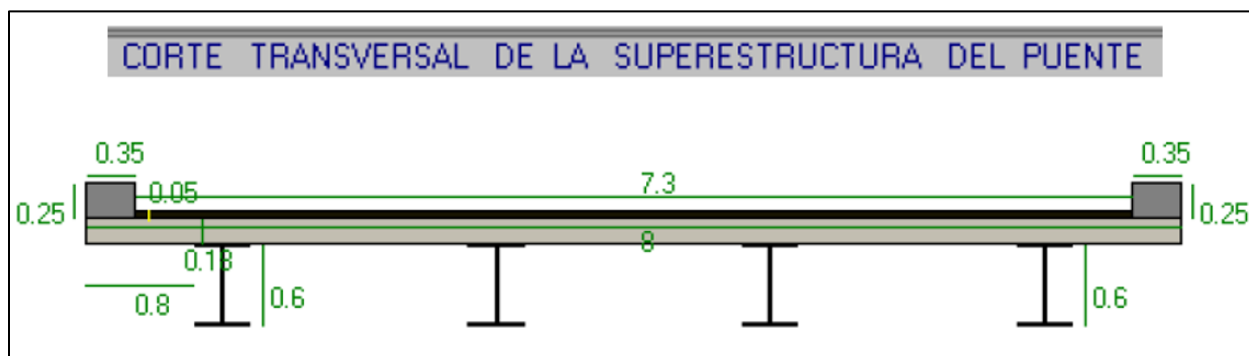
Esquema de la superestructura del puente en perfiles metálicos.
